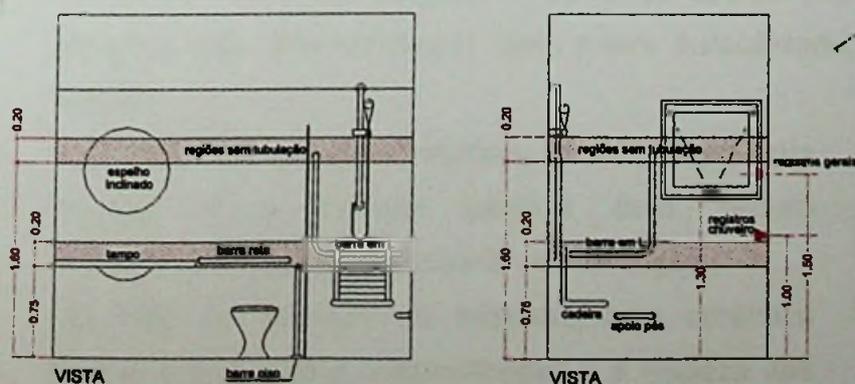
Desenho dos detalhes da instalação hidráulica, com previsão para instalação de barras de apoio
